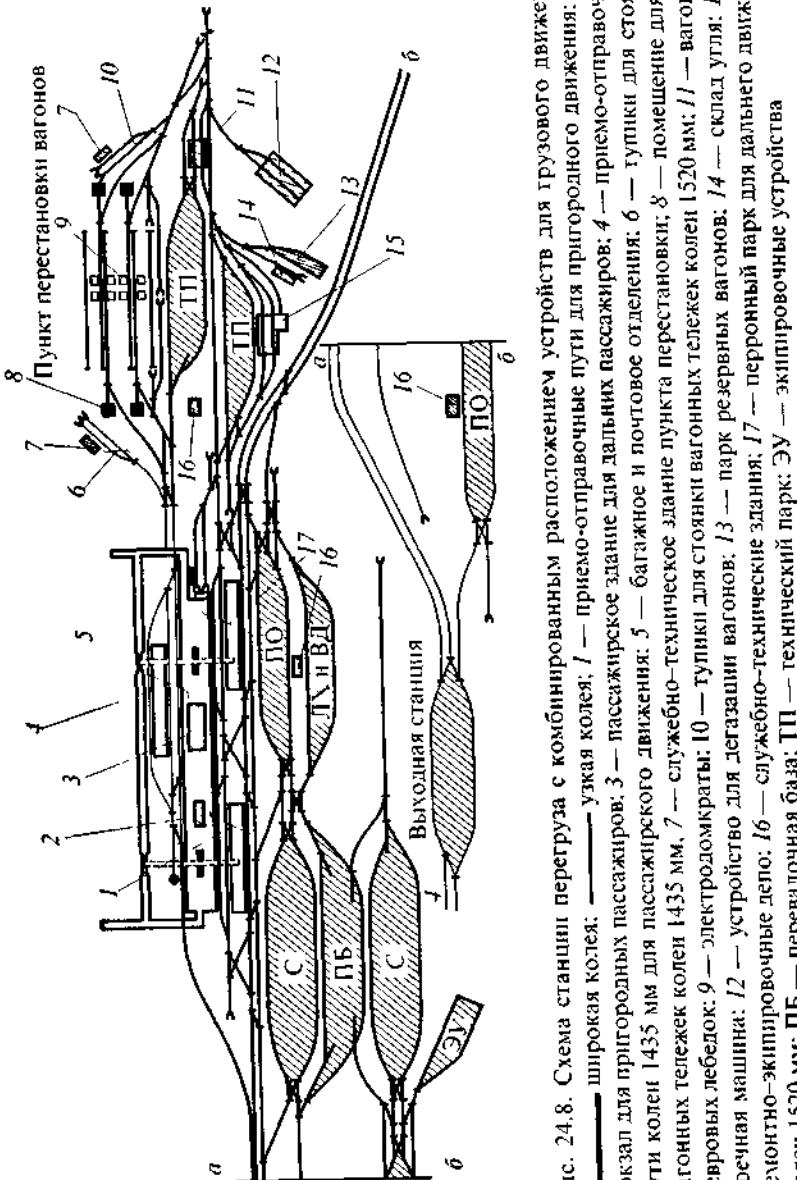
Схема станции перегрузки с комбинированным расположением устройств для грузового движения:
